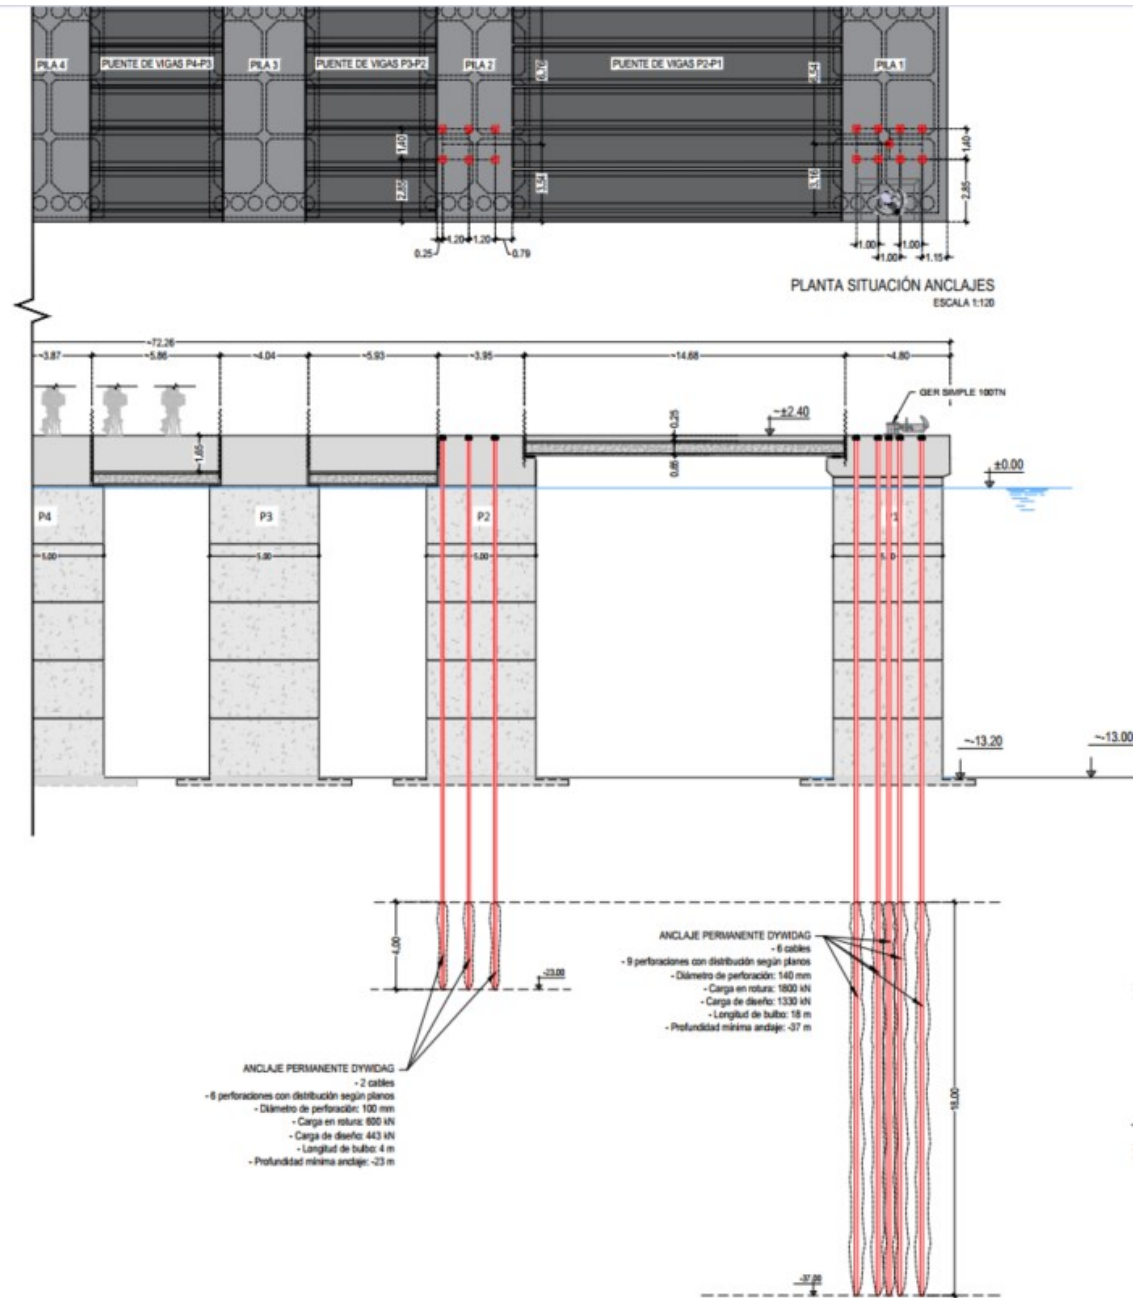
Anclaje en pilas P2 y P1. Planta y Alzado.
